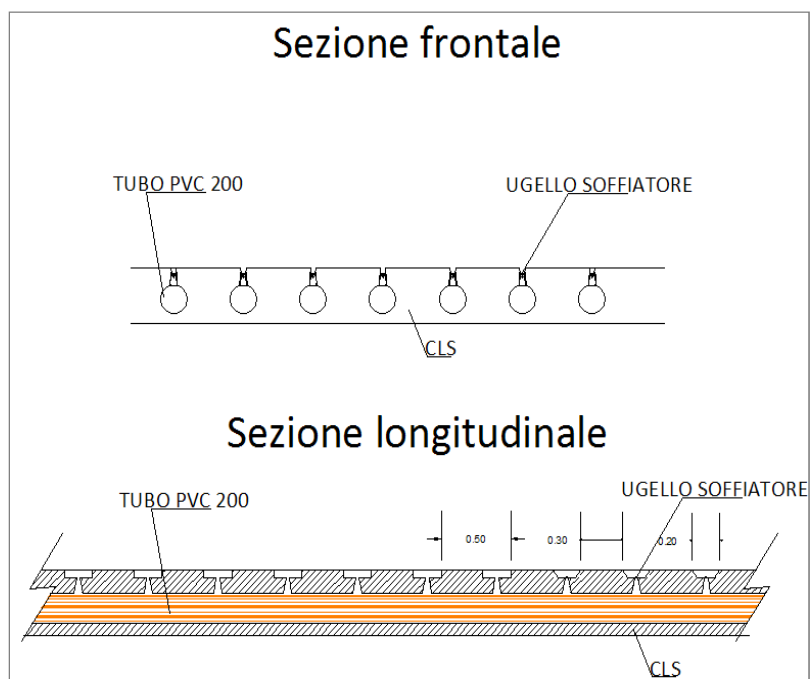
Sezioni tipo di pavimentazione insufflata.
